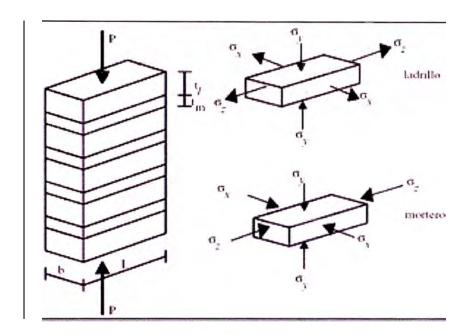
Comportamiento teórico de la pila de albañilería sometida a esfuerzos de compresión.
